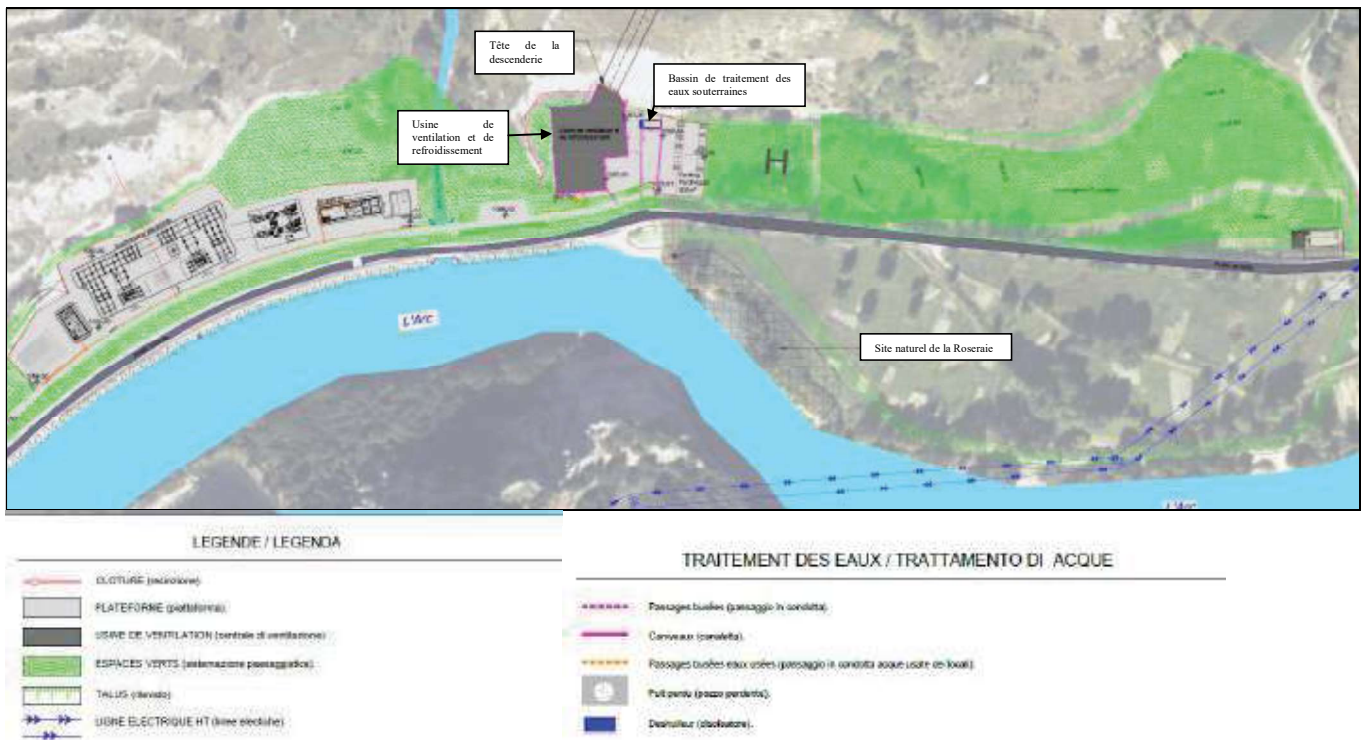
Croquis présentant les aménagements envisagés pour le secteur de Villarodin-Bourget/Modane – Source: Plan de masse sur orthophoto- génie civil- tunnel de base- accès Modane- portail et plateforme- référence: PR_C3A_TSE3_4102_0_26-12-30_30-02_Plan de masse orthophoto
